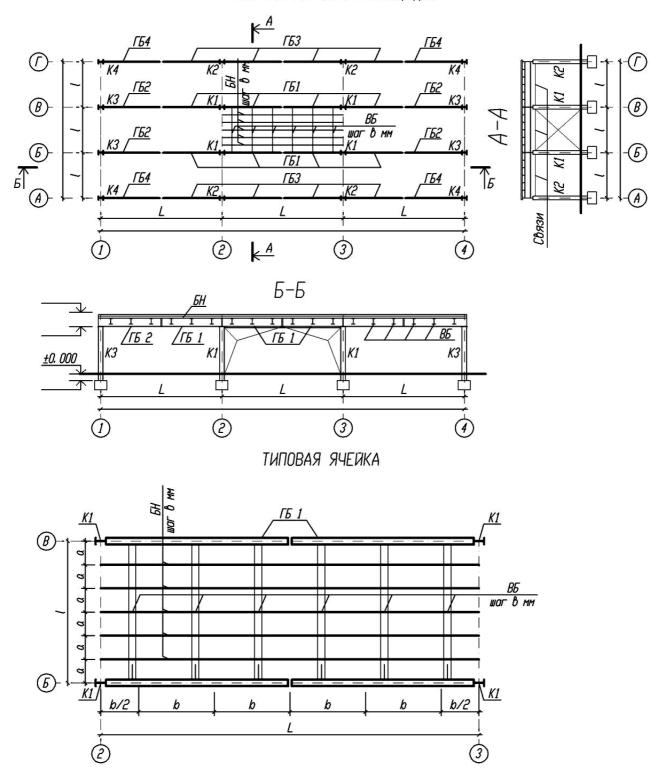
Усложнённый тип балочной клетки со смещением ВБ относительно осей колонн на половину шага, сопряжение БН и ВБ с ГБ – пониженное, опирание ГБ на колонну сверху
